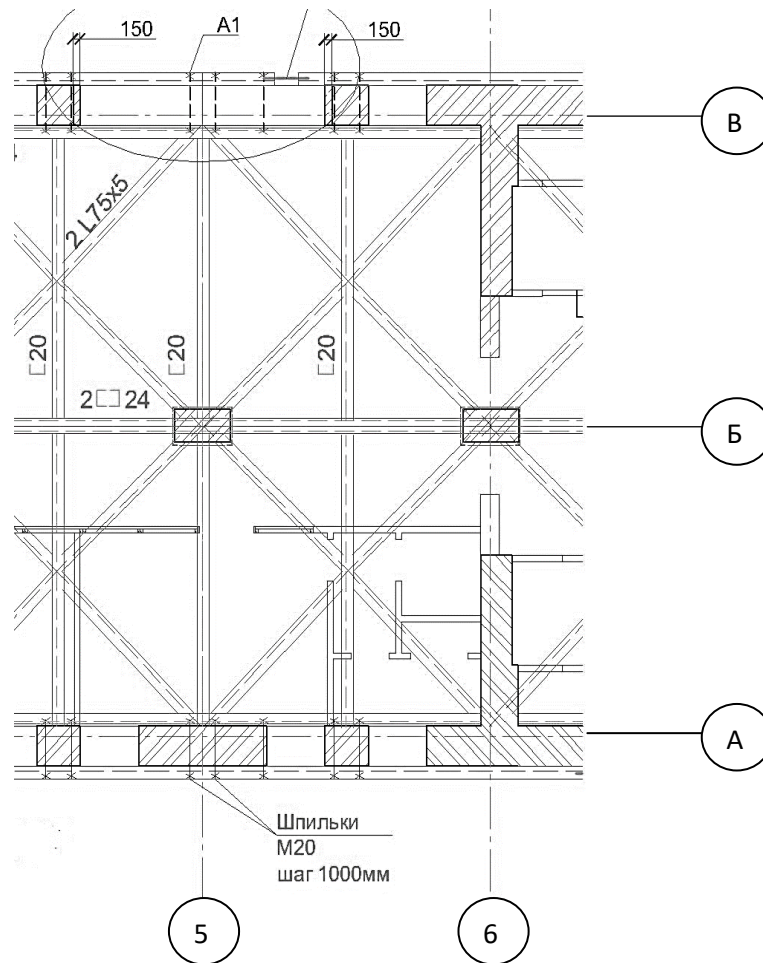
Фрагмент расположения усиленных перекрытия (под потолком первого этажа)
